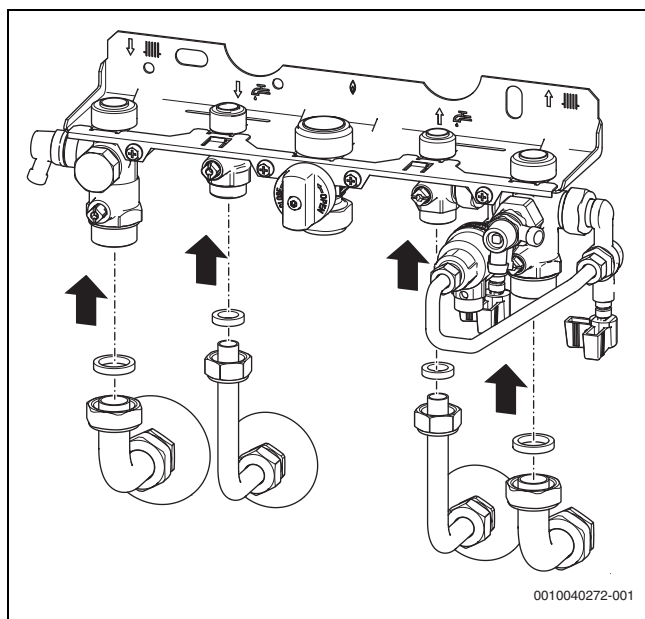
Rohre mit Dichtungen an Montageanschlussplatte montieren
